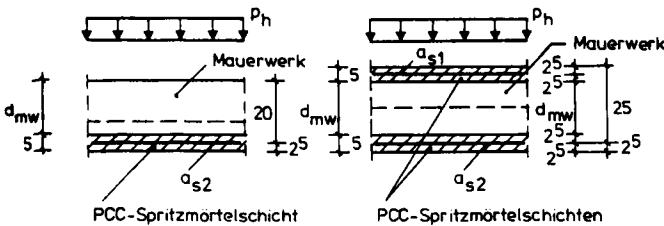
Horizontale Traglasten durch betonstahlbewehrte Ergänzungsschichten verstärkter, einachsig lastabtragender Mauerwerkswände: Variation des Bewehrungsgehaltes
